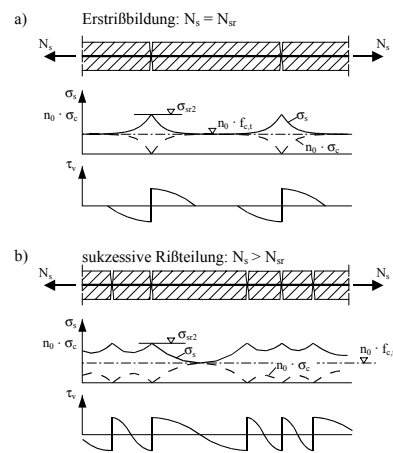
Beanspruchungen im Betongurt bei Erstrissbildung und bei sukzessiver Rissbildung nach [9]
